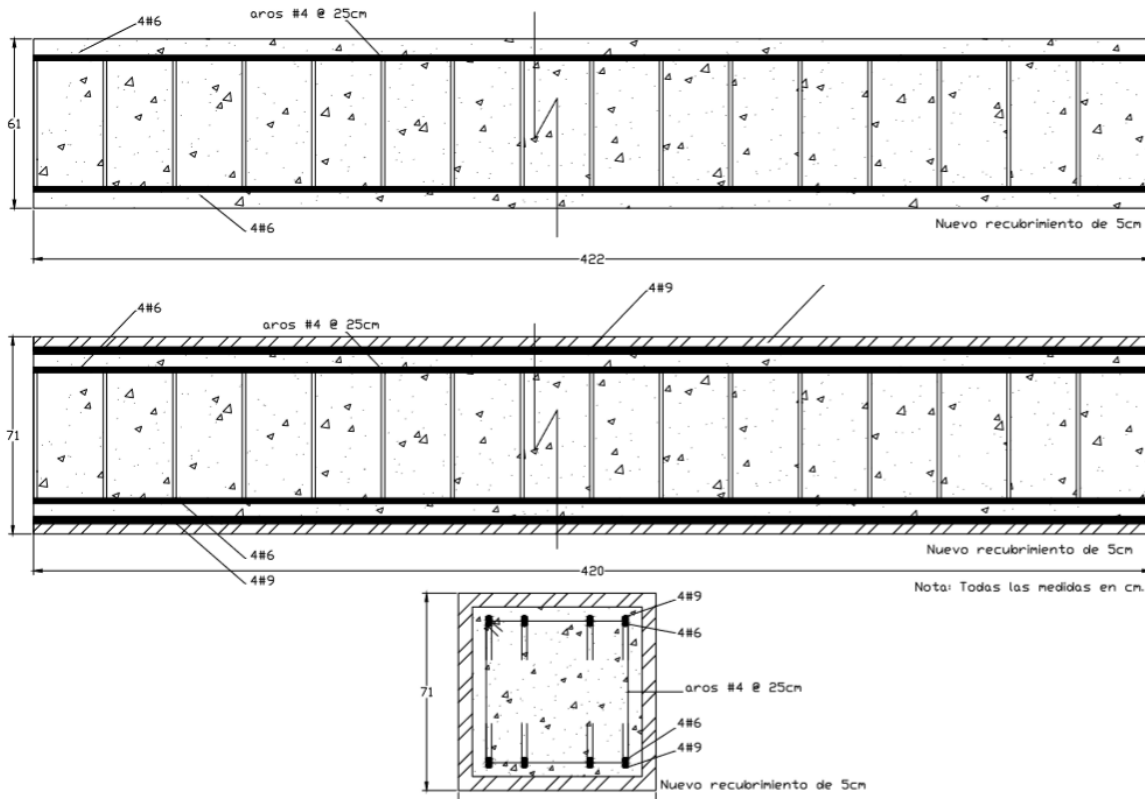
Detalle de la sección original de la viga secundaria (arriba) y detalle de la propuesta de reparación seleccionada (abajo) con nueva sección transversal. Fuente: Elaboración propia.
